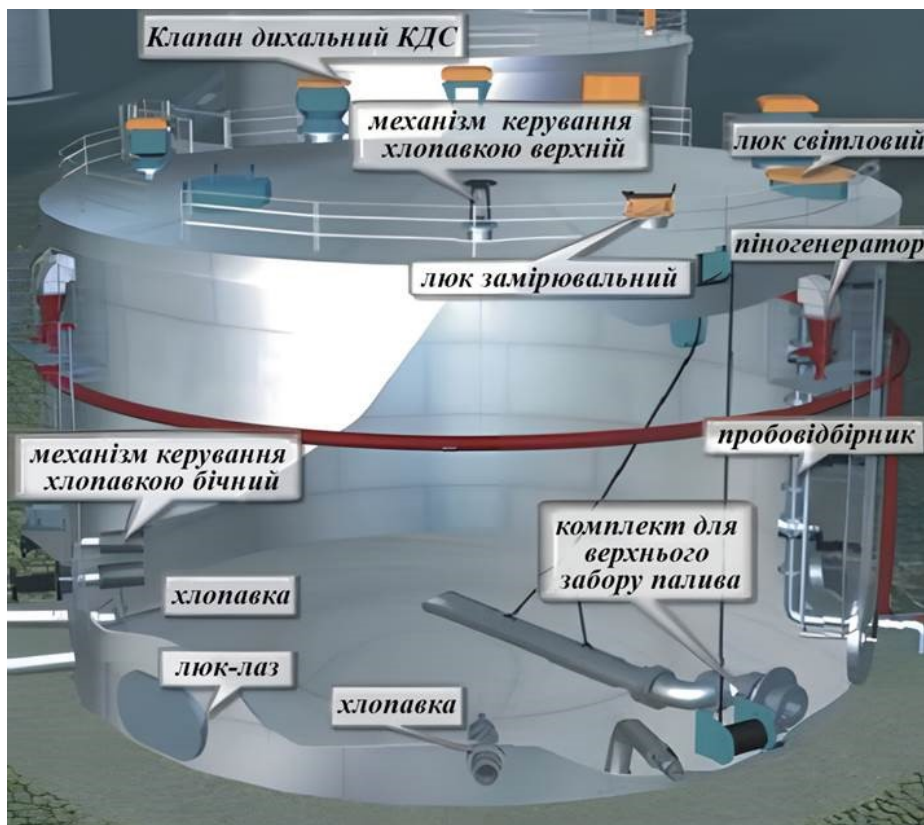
Обладнання вертикального сталевого резервуара
